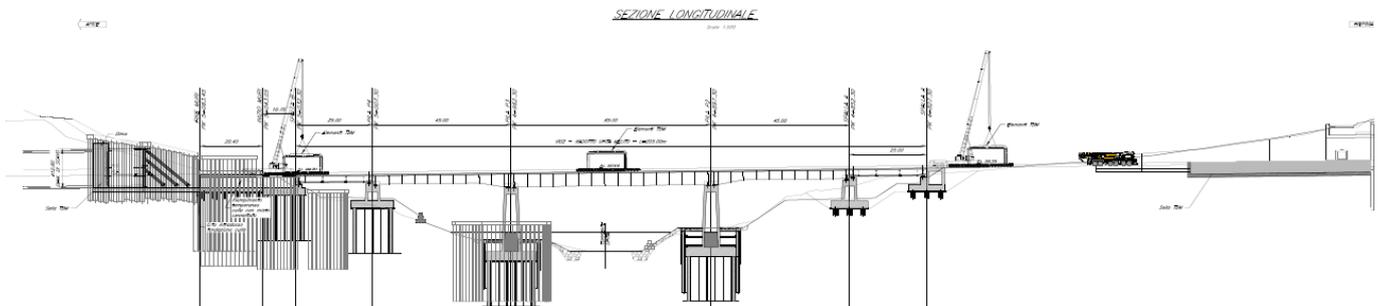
Traslazione TBM lungo il viadotto VI02 – Sezione longitudinale
